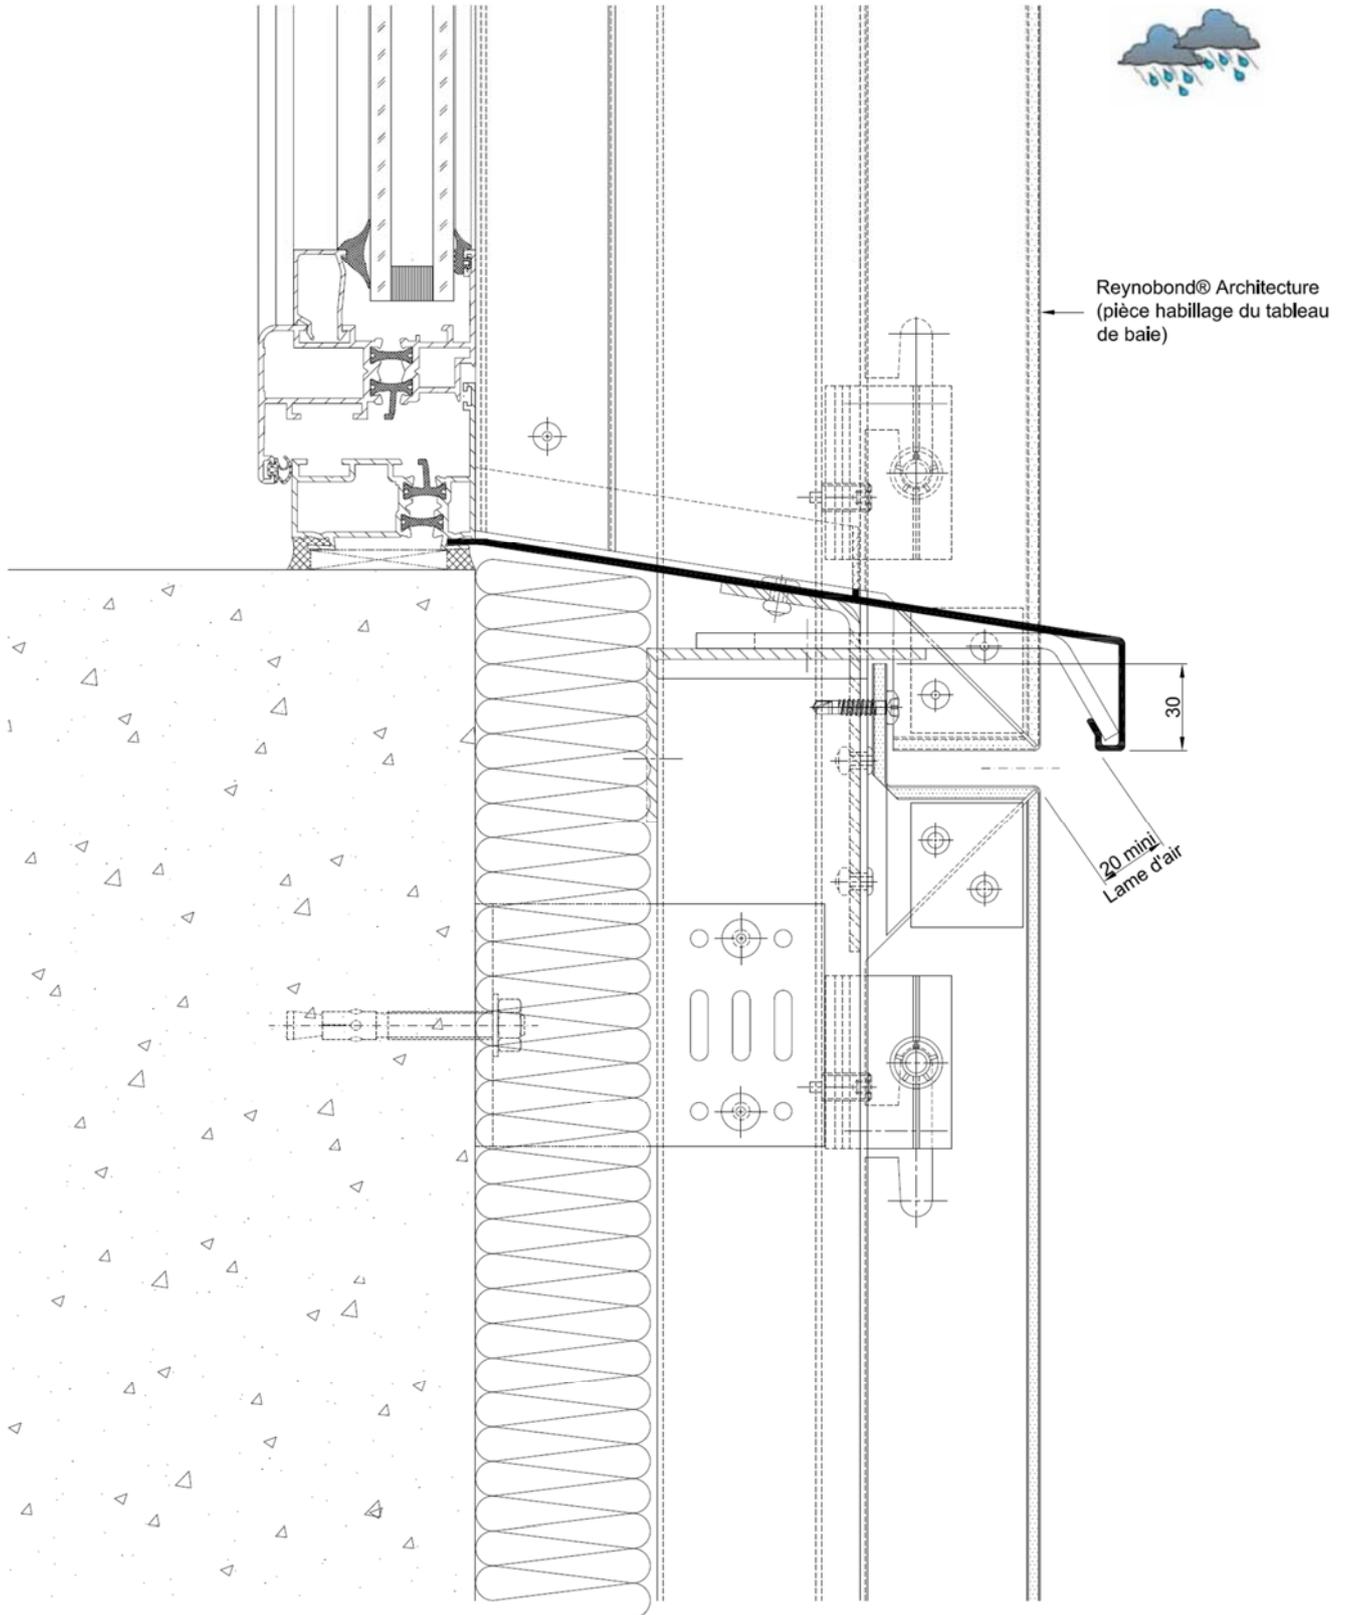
Détail tablette de fenêtre – Coupe verticale
